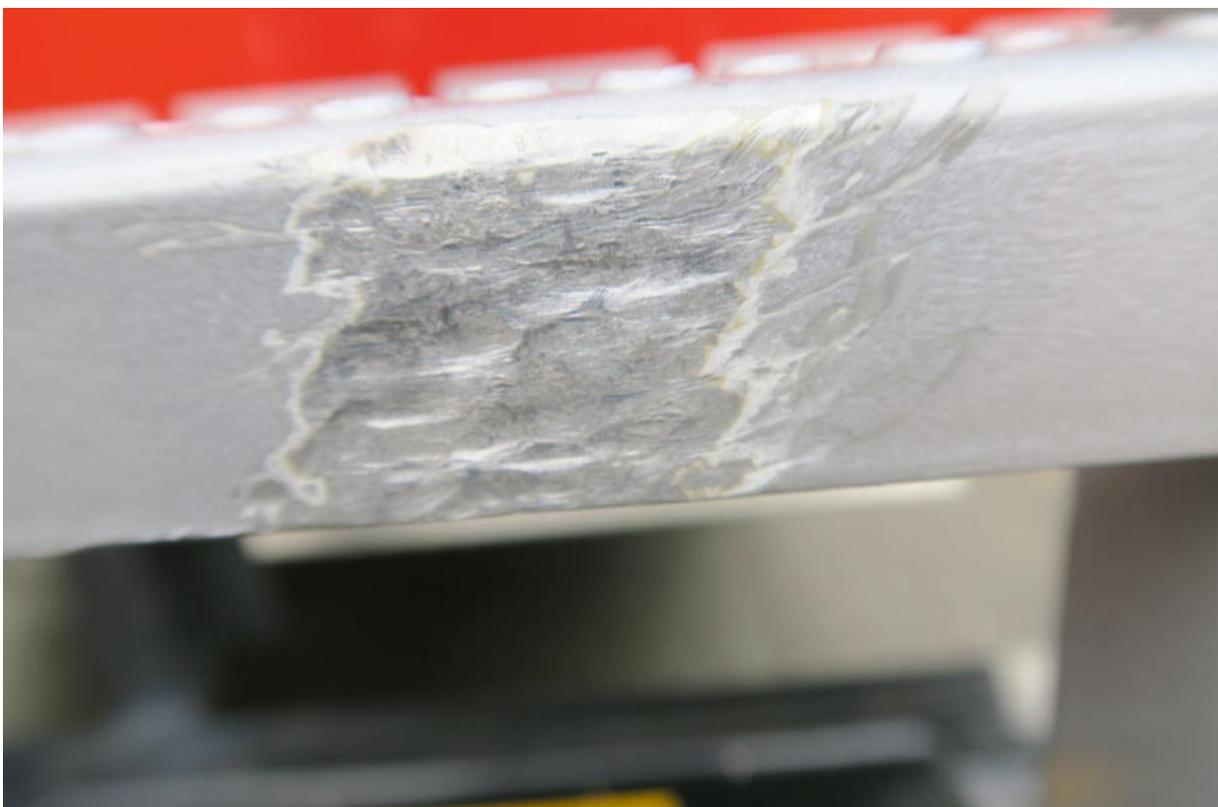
Dachaufstiegsleiter oberflächlich beschädigt
